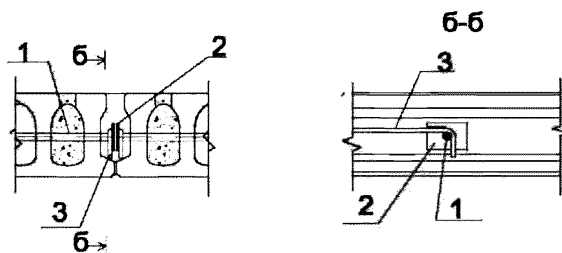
Фрагмент анкеровки арматурного выпуска в шве между плитами перекрытий: 1 – монтажный стержень для подъема плит; 2 – стальная пластина приварена в торец монтажного стержня; 3 – анкер
